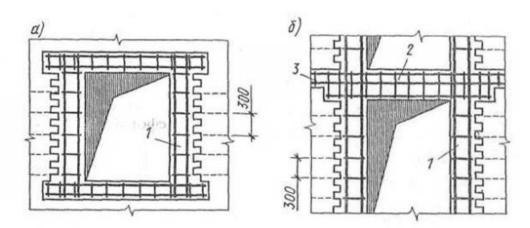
Усиление граней оконных (а) и дверных (б) проемов: 1 - железобетонный сердечник; 2 - железобетонная перемычка, объединенная с объязкой; 3 -железобетонная объязка
